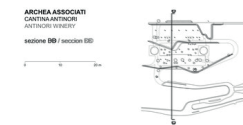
Arch Daily, Sección del sitio de las bodegas de Antinori. (2012) Croquis (Archivo Arch Daily)
